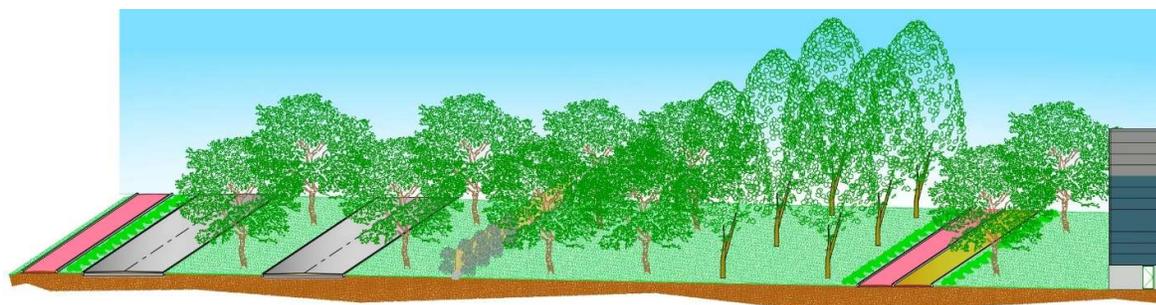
Tavola PEC 16: Planimetria progetto verde Comparto 5.1.2
